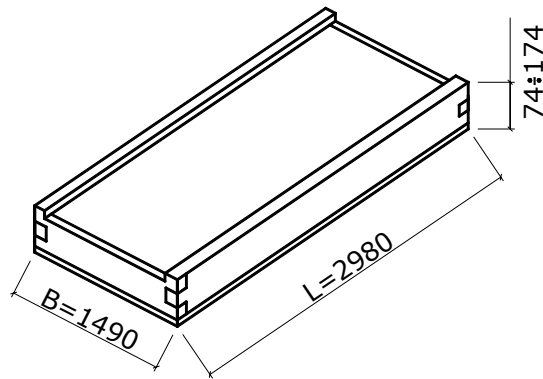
Плита покриття типу "сендвіч" з обшивкою з асбестоцементних, деревоволокнистих плит та утеплювача з фенольного пінопласту
